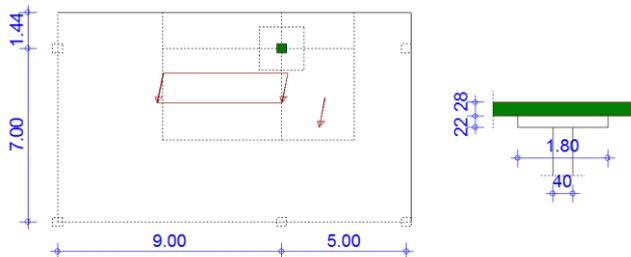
Deckensystem mit Lasteinleitungsfläche und Belastung
